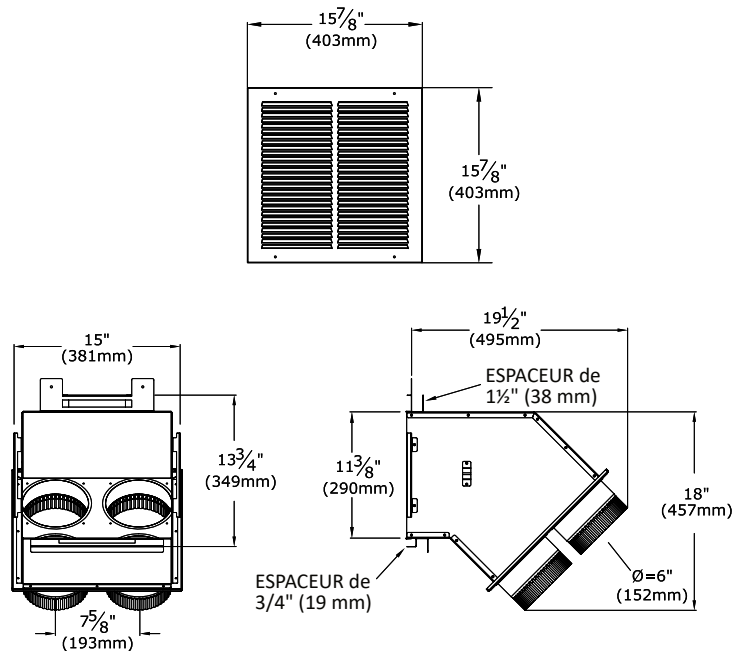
Vue d'ensemble du kit KZK-1616
